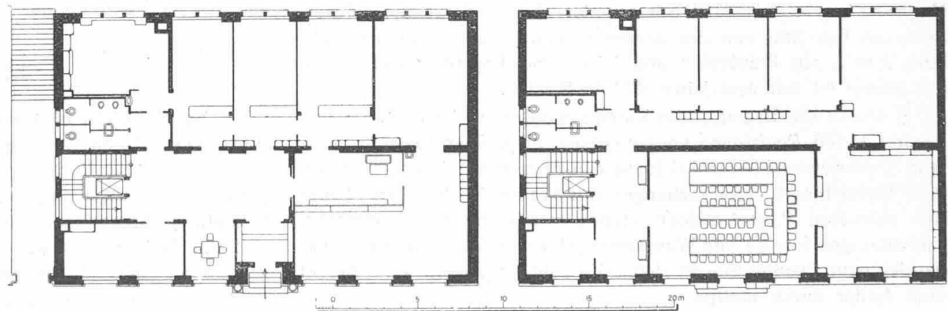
und 5. Grundrisse vom Erdgeschoss und I. Stock. — Masstab 1:400.
